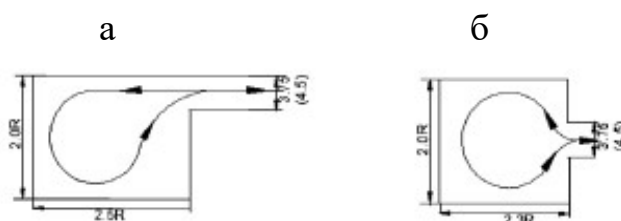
Разворотные площадки на тупиковых внутривозрадных дорогах: а – проезд сбоку площадки; б – проезд посередине площадки
